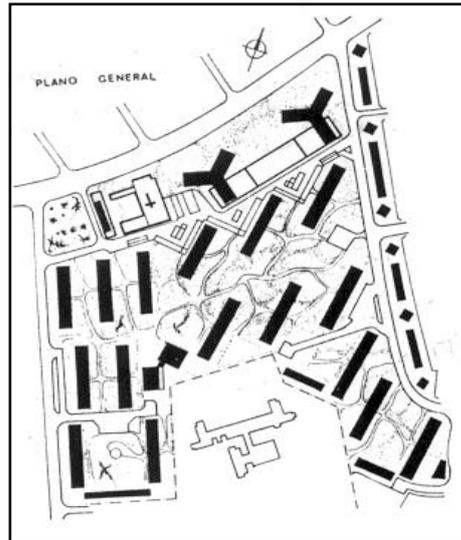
Unidad Vecinal Providencia. Planta del Conjunto. 1961.
